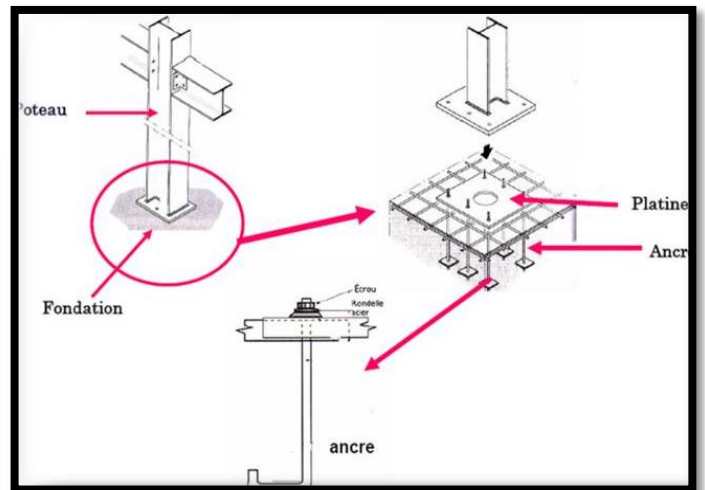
fixation d'un poteau mixte sur la semelle avant l'enrobage
